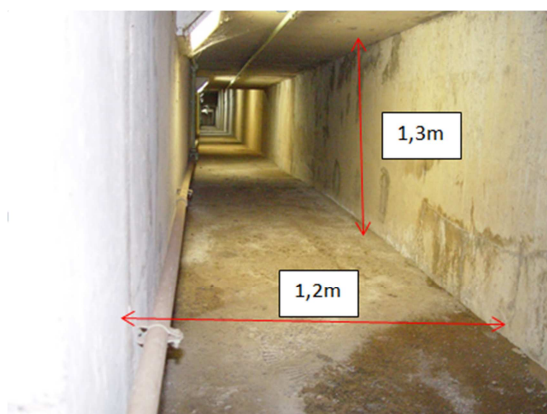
à esquerda: Vista da continuação da galeria em direção aos terminais. (corte A-A de 6641-DF-88805)
